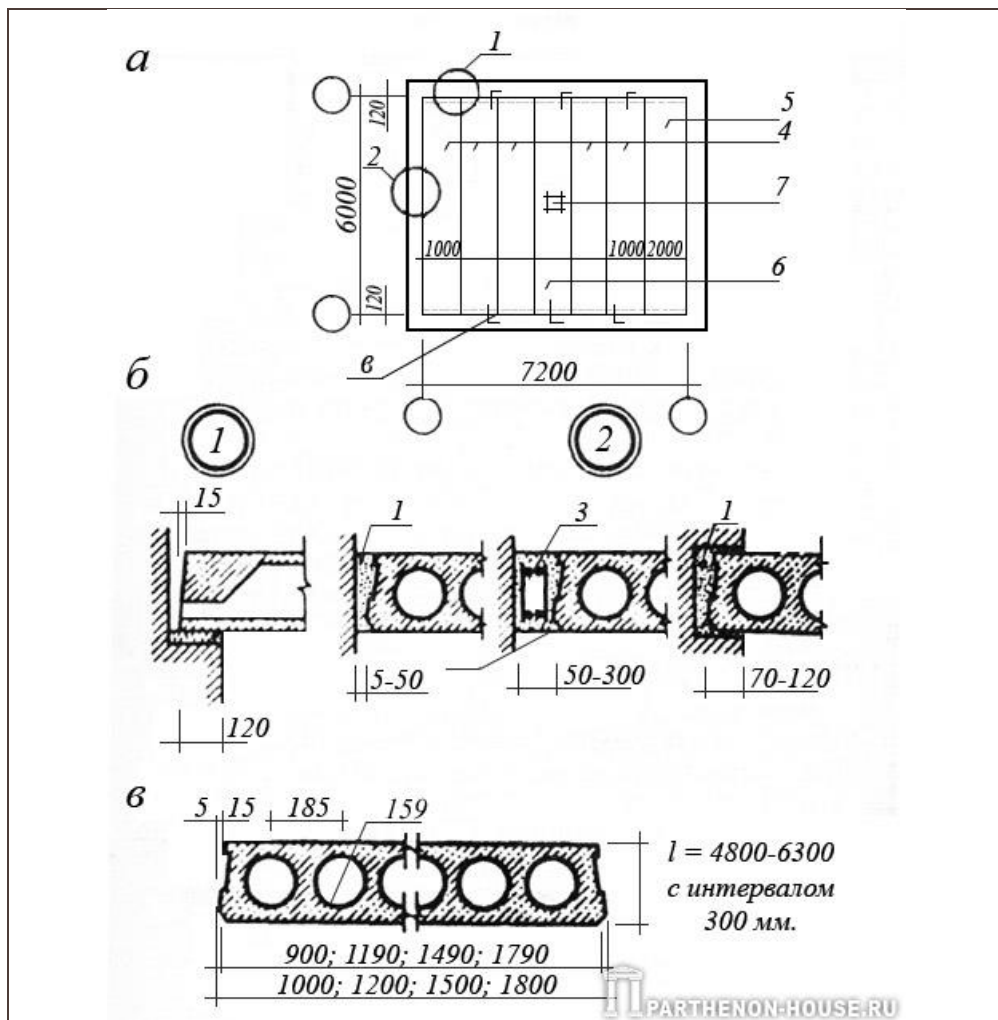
Схема плитного железобетонного перекрытия кирпичного дома: а - схема перекрытия; б - деталь опирания панели на стену и примыкания ее к стене; в - панель перекрытия с круглыми пустотами; 1 - цементный раствор; 2 - бетон; 3 - арматурный каркас, 4 и 5 - сборные железобетонные плиты; 6 - то же, с отверстием; 7 - отверстие для дымовой трубы; 8 - стальной анкер
